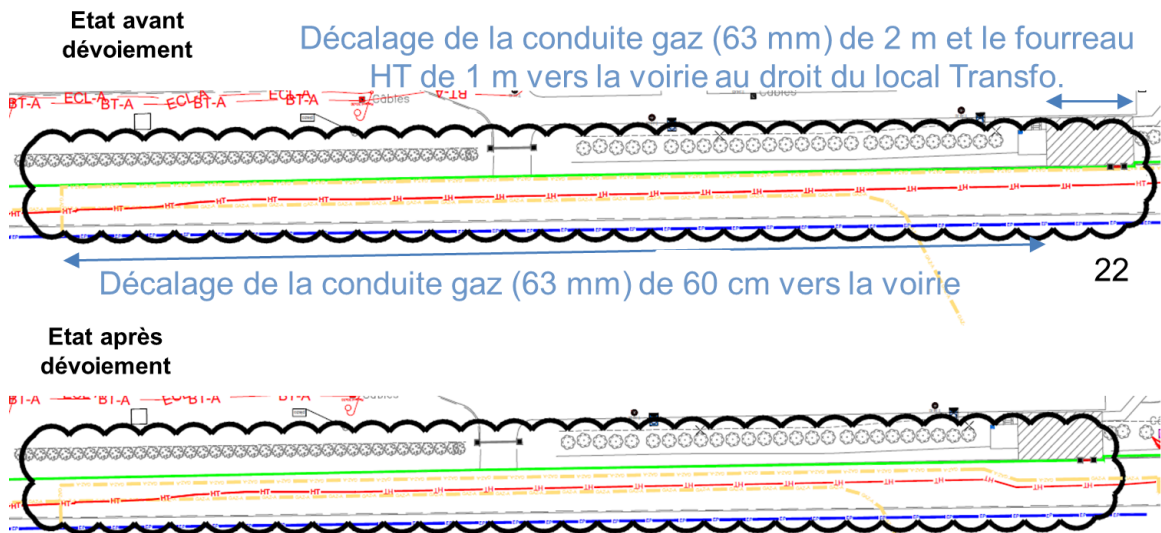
Dévoiement de la conduite de gaz (63 mm) et le fourreau HT à proximité du mur au Nord et du local transformateur
